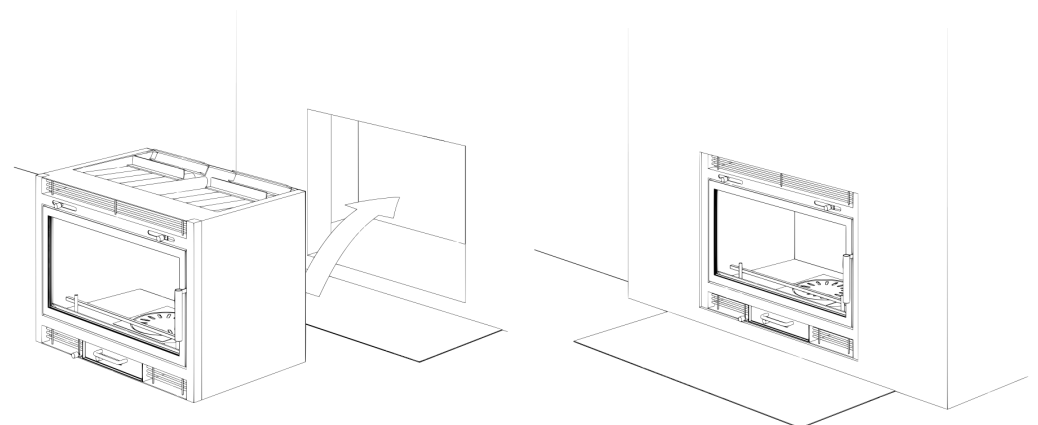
Schema der Brandschutzsicherung der IGNIF-Kaminkassette, Grundriss
